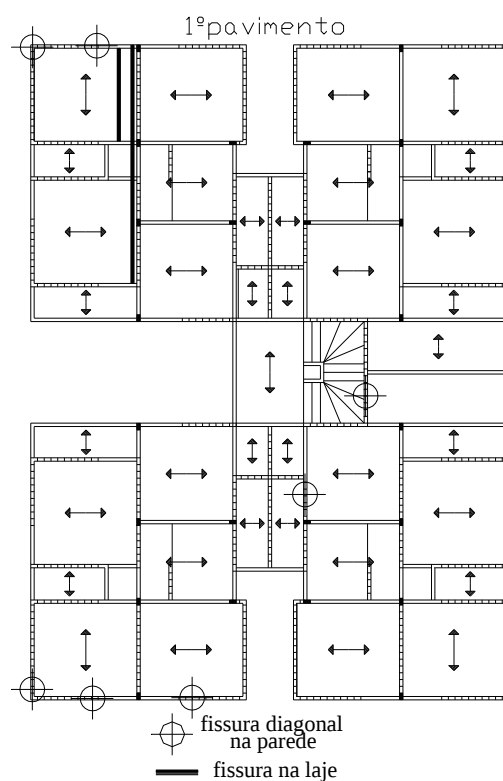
Panorama de fissuração no 1º pavimento.
